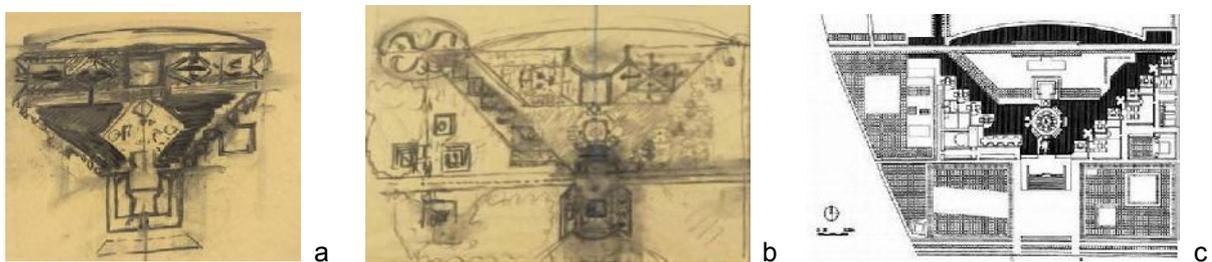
Complexo da Assembléia Nacional de Dacca. Evolução de diagramas à planta de implantação. a) Croqui do arquiteto, 1963. Fonte: <www.moma.org>. b) Croqui do arquiteto, 1964. Fonte: <www.moma.org>. c) Planta de implantação do complexo. Fonte: <www.greatbuildings.com>. Imagens editadas pela autora.
